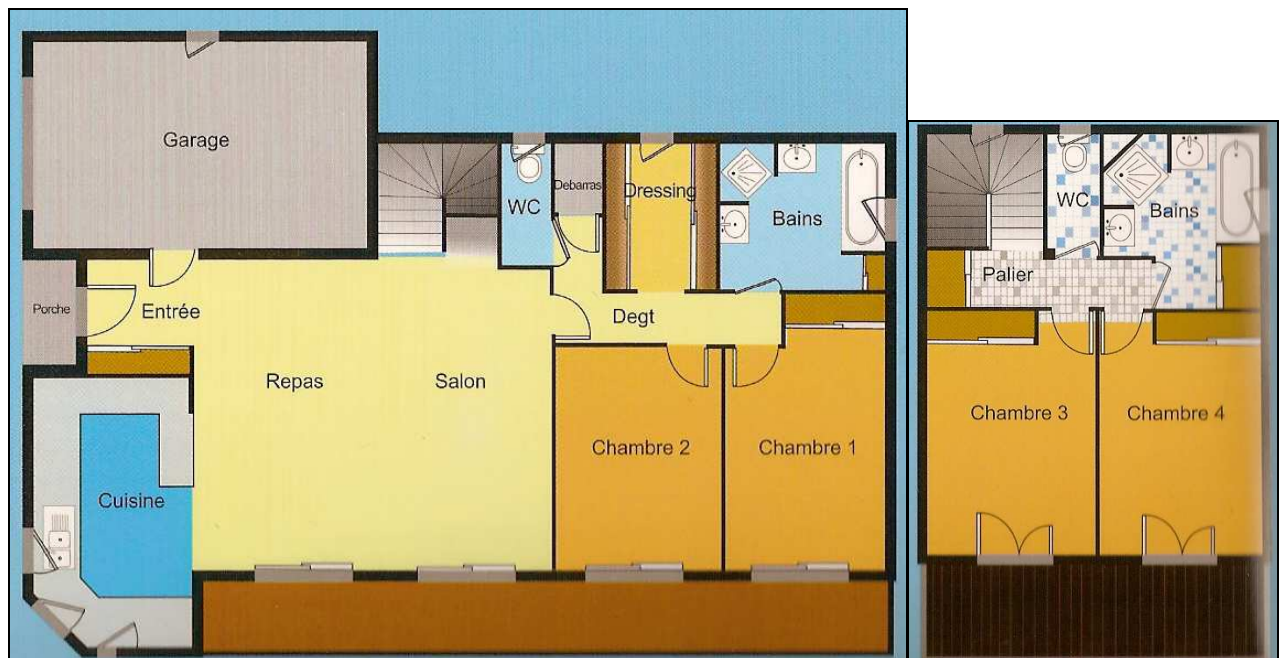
Maison Giraud-Ruet, plan rez-de-chaussée.
